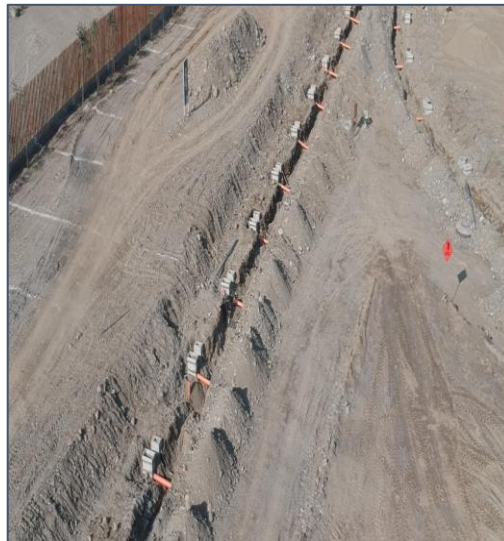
Vista de conexiones domiciliarias de alcantarillado.
